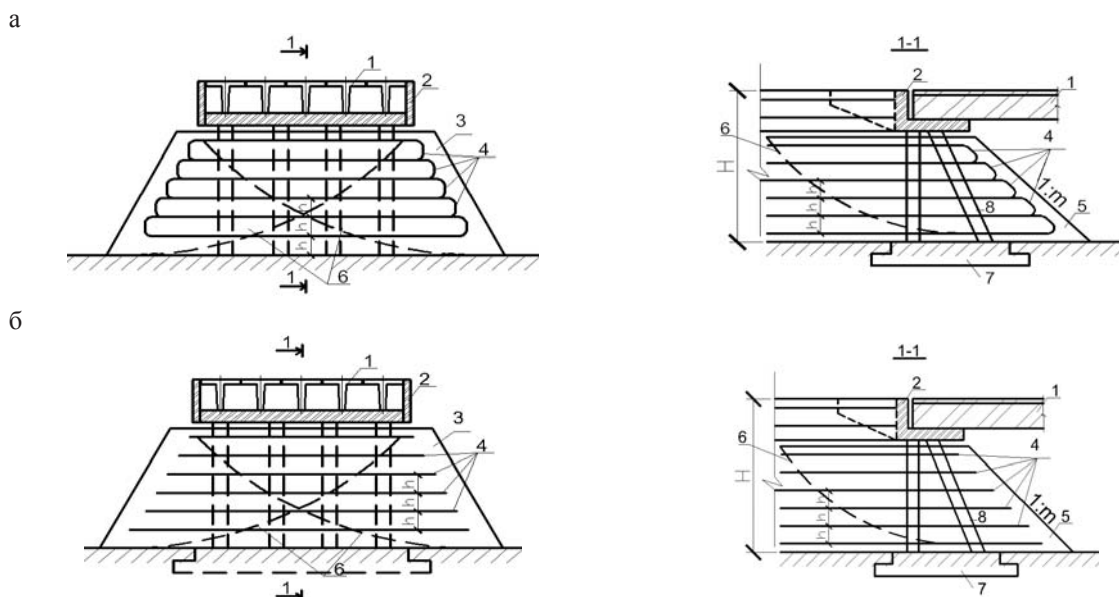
Схема армирования насыпи с устоем козлового типа: а – несвязные грунты; б – связные грунты; 1–6 – то же, что на рис.1; 7– фундамент; 8 – стойки.
